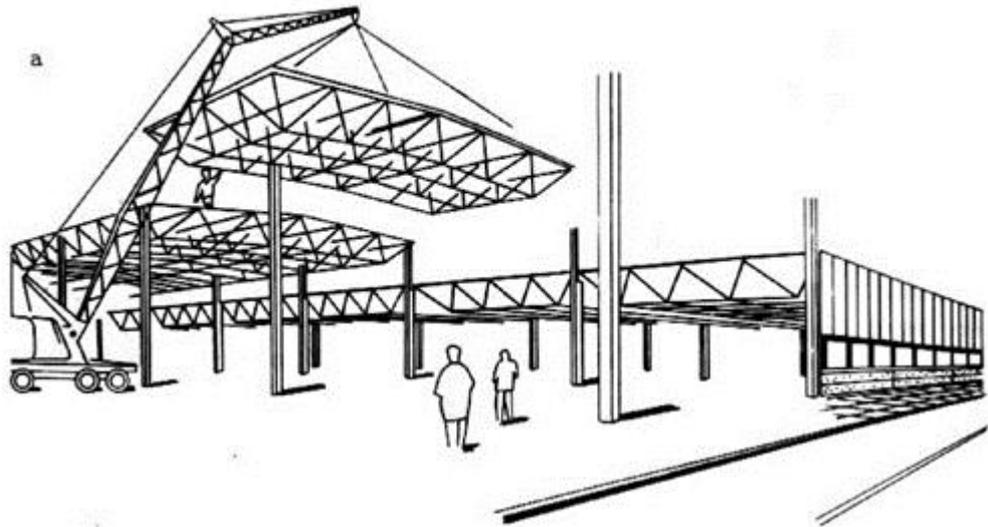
Об'ємно-планувальний елемент будівлі, виконаний зі змішаними конструкціями і з структурною плитою перекриття типу «Берлін»
